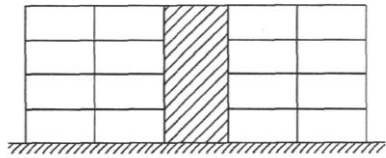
Конструкції з бетонними ядрами або бетонними стінами.
